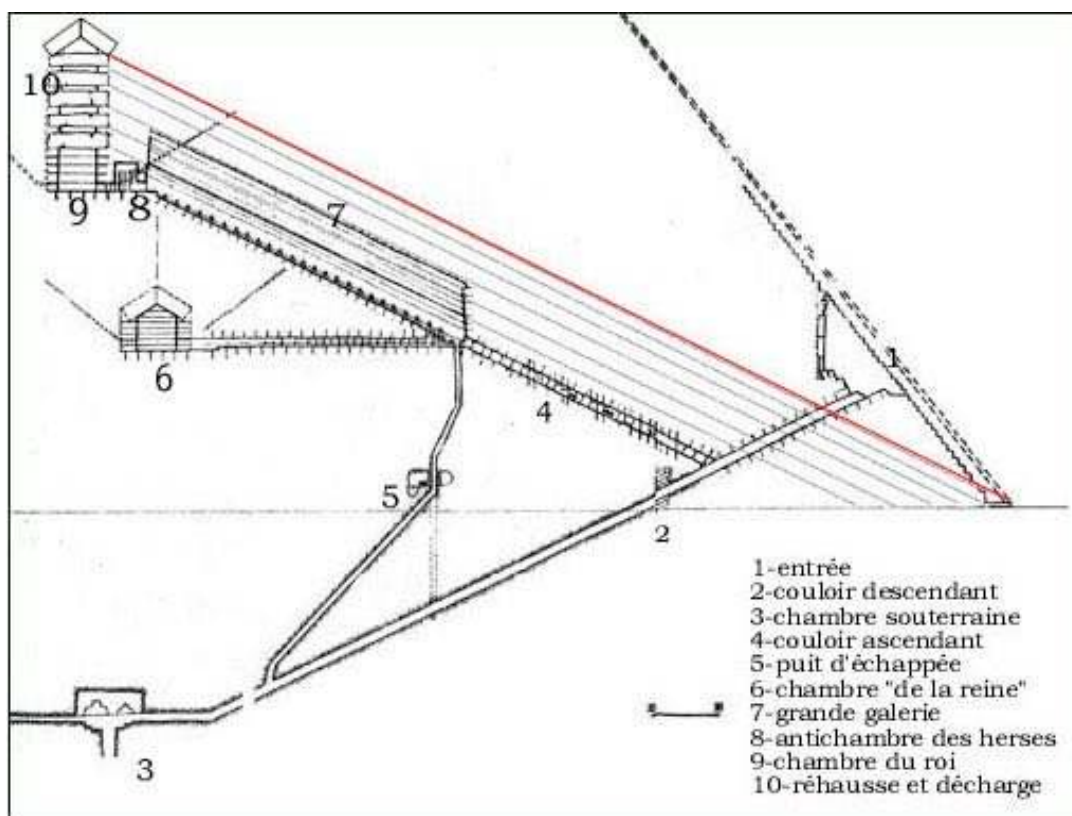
Le couloir ascendant et tout un faisceau de plans inclinés
